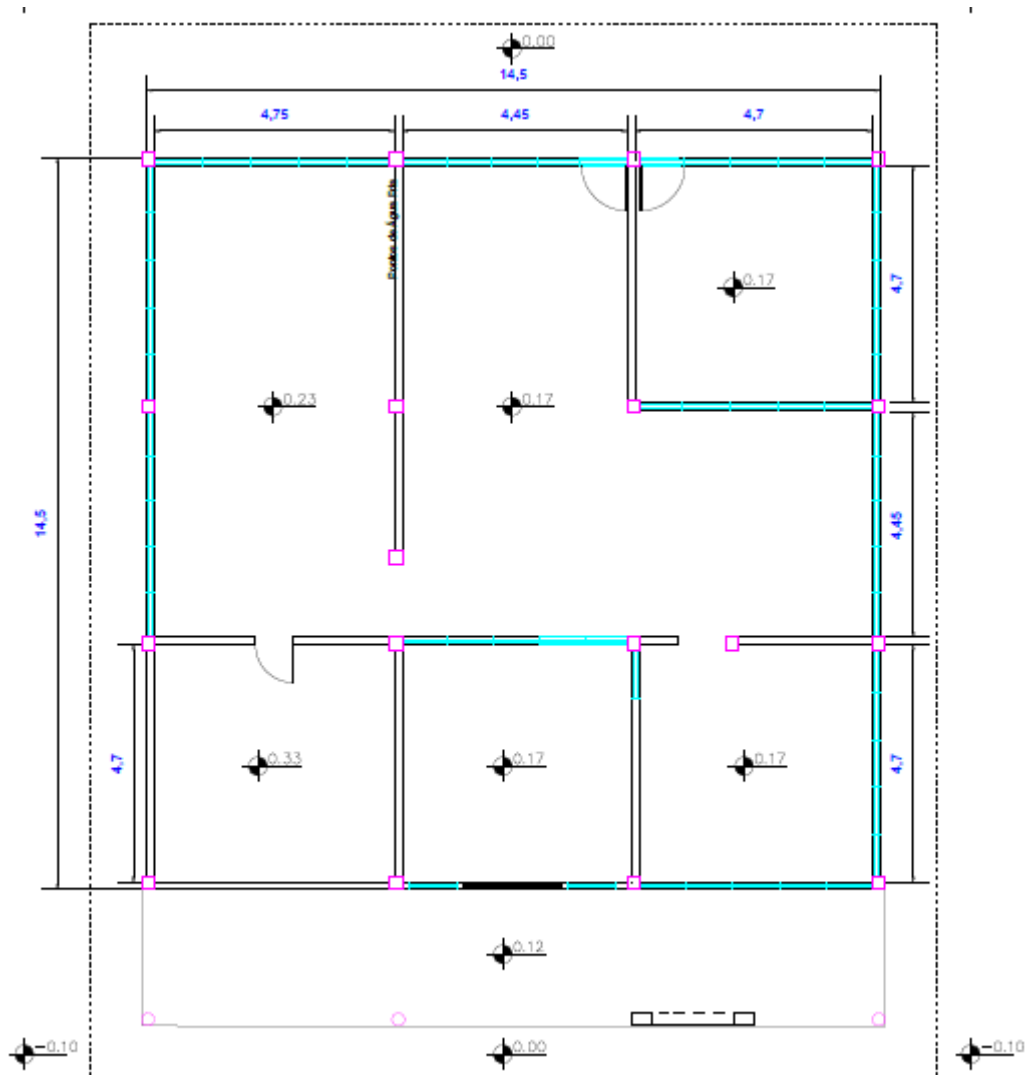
Planta baixa da 02_ARQ_AGROINDÚSTRIA_EXISTENTE
